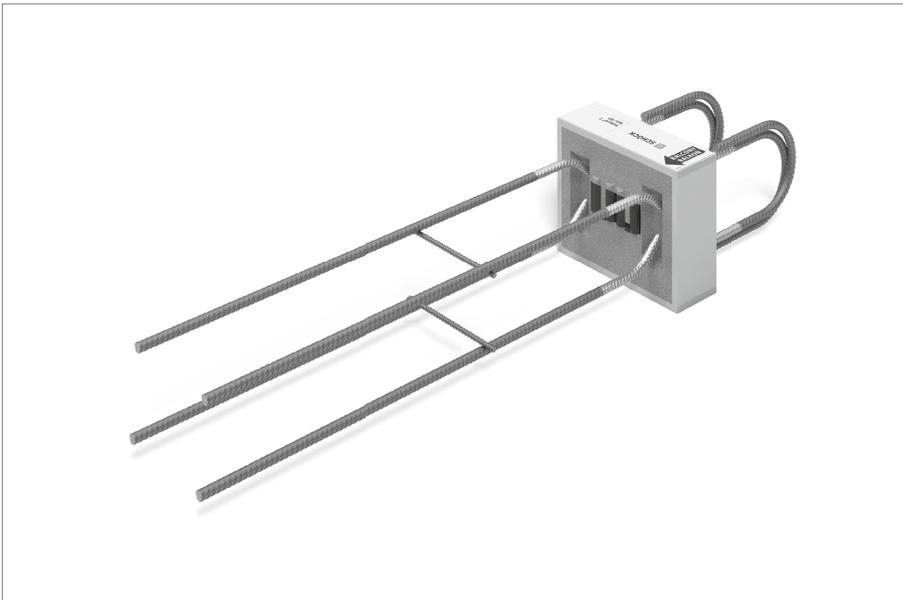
Schöck Isokorb® T Typ QP: Brandschutzausführung rundum mit Brandschutzplatten bekleidet
